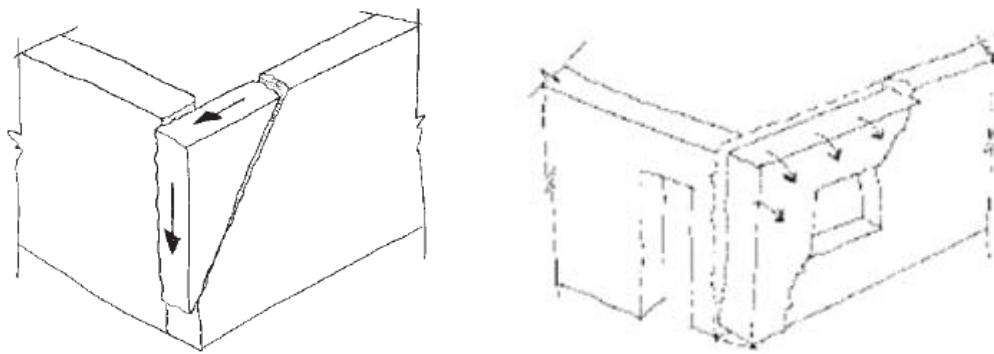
Corner crack* e instabilità locale all'angolo di un edificio.
